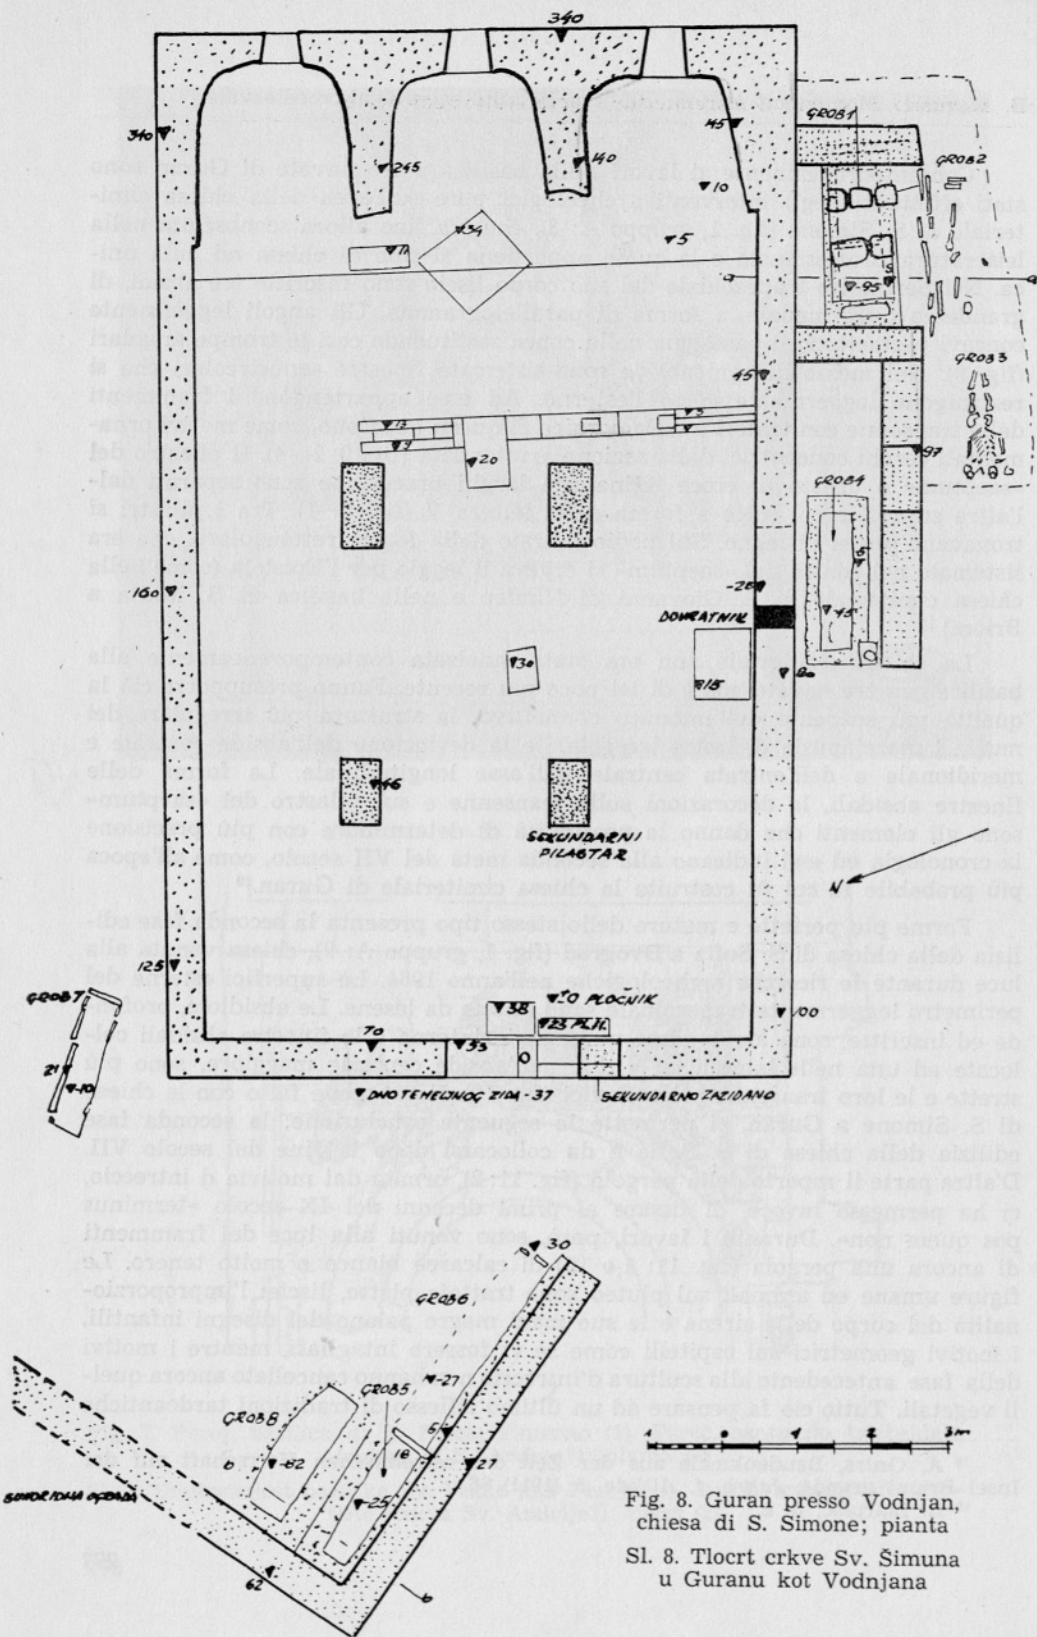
Guran presso Vodnjan, chiesa di S. Simone; pianta
